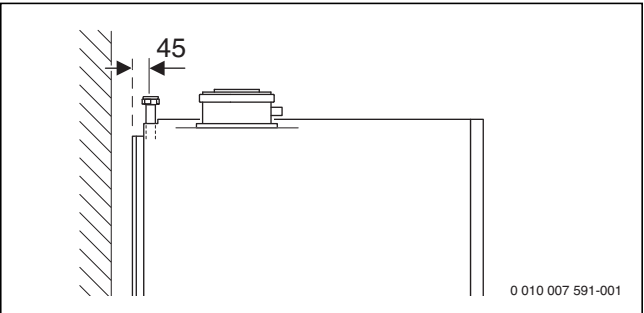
Anschlussmaße des Zubehörs CS 14 (Maße in mm)
